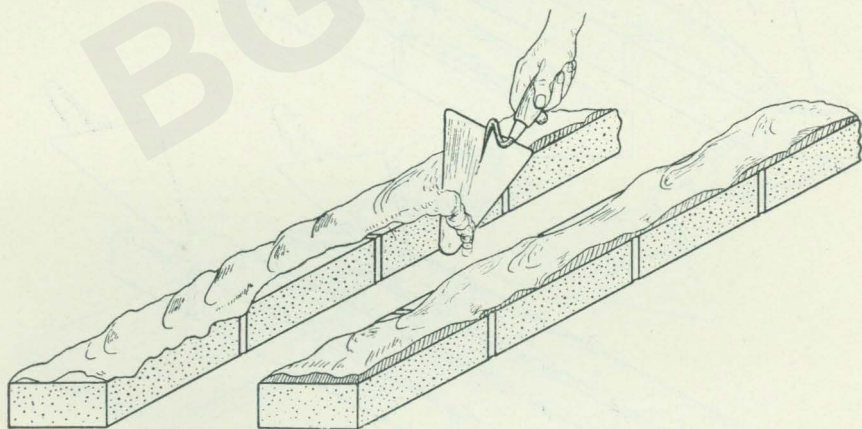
Zaprawa po narzuceniu. Nakłada się ją na cegły cementowe, pozostawiając po bokach wolne przestrzenie.
